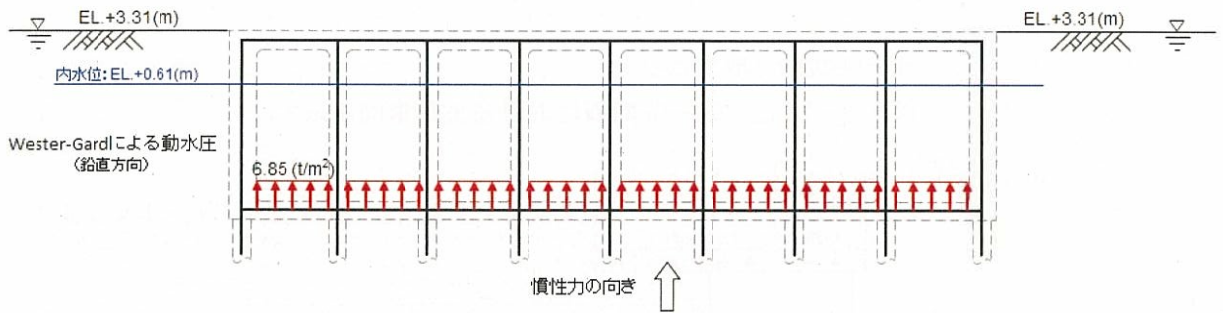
(2) 鉛直動による動水圧図 (①-①断面)
